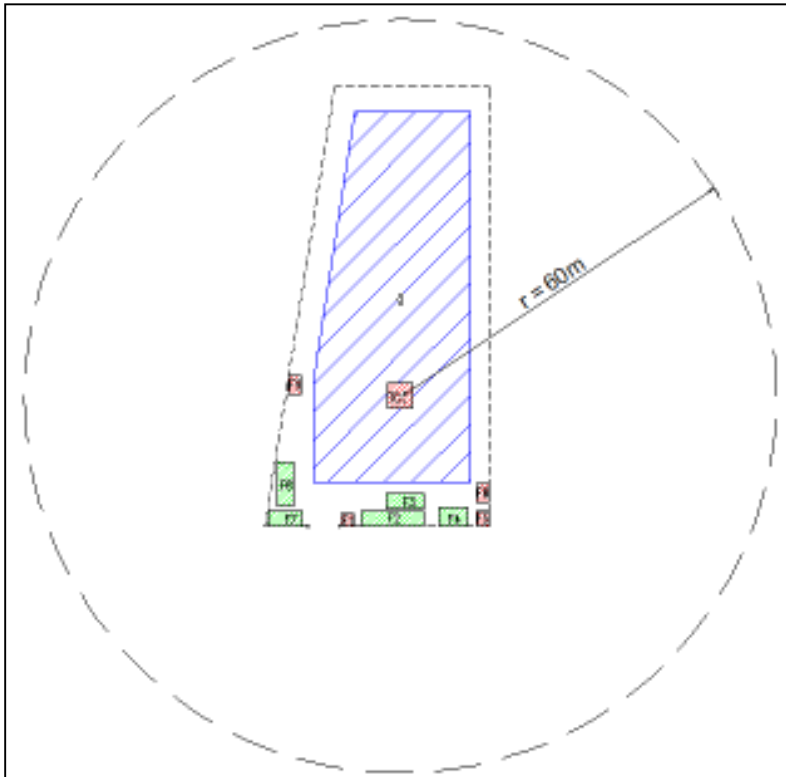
Tampak Gedung Apartemen Paviliun Permata Tower 2
